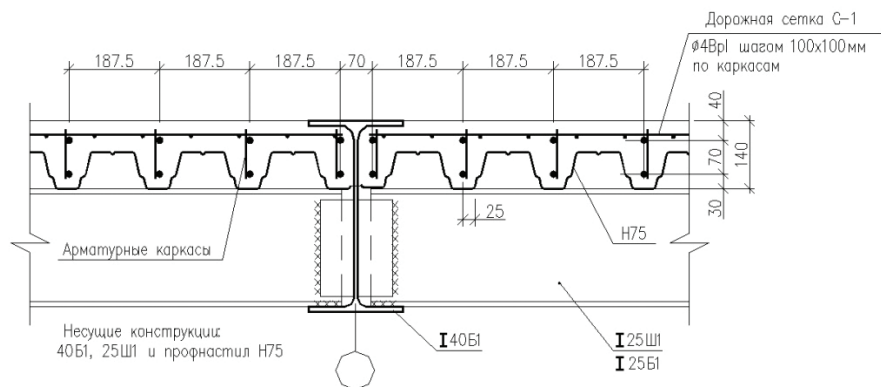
Пример монолитного железобетонного перекрытия по профилированному настилу
